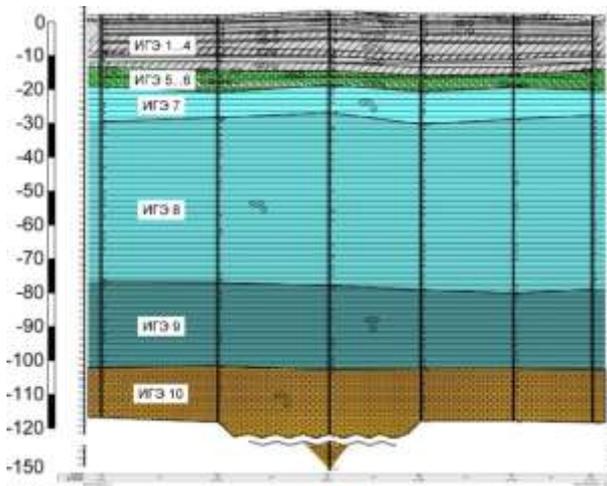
Инженерно-геологические условия площадки строительства здания «Лахта Центр»:
